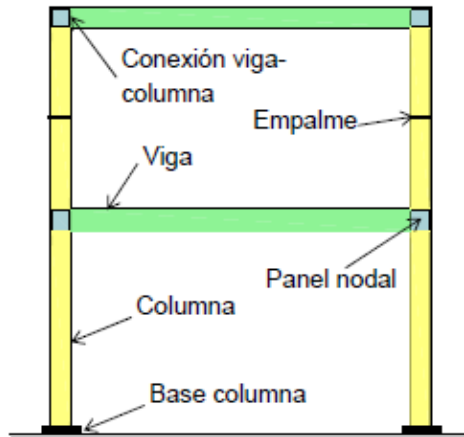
Componentes estructurales de un pórtico resistente a momento (Crisafulli, 2018)
